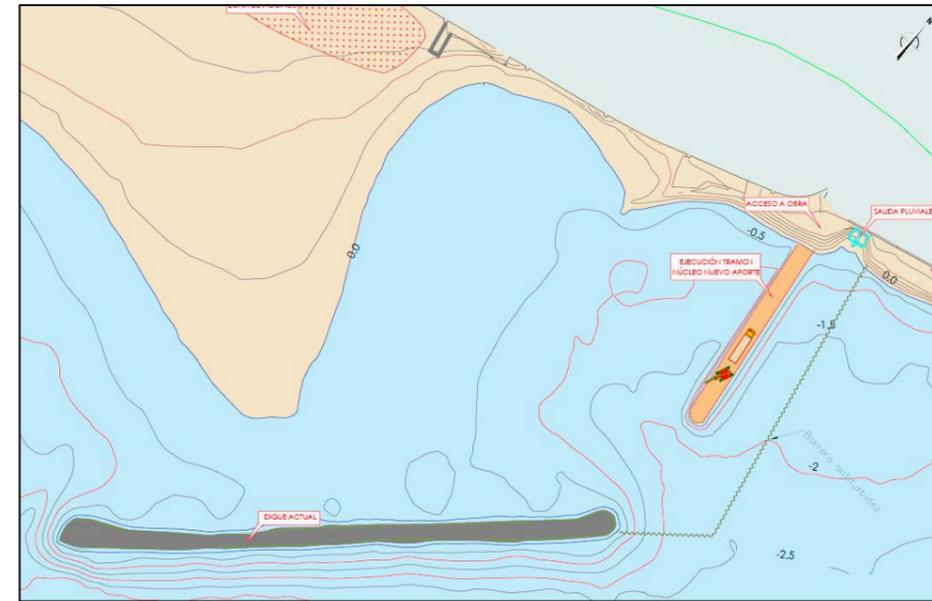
Disposición de la barrera antiturbidez en la primera etapa del proceso constructivo.
